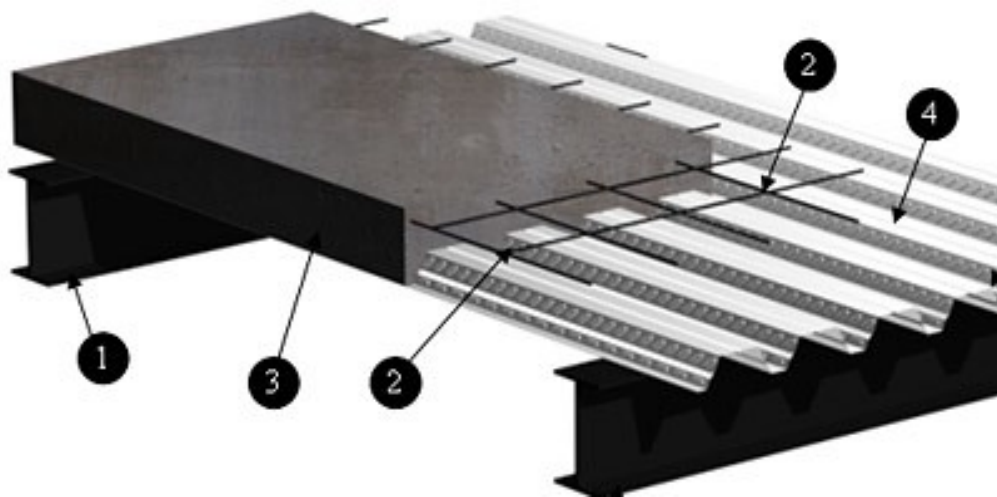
Монолітне перекриття по профільованому настилу: 1 – балка перекриття; 2 – арматура; 3 – бетон; 4 – профнастил ; 5 – шуруп (гвинт).
